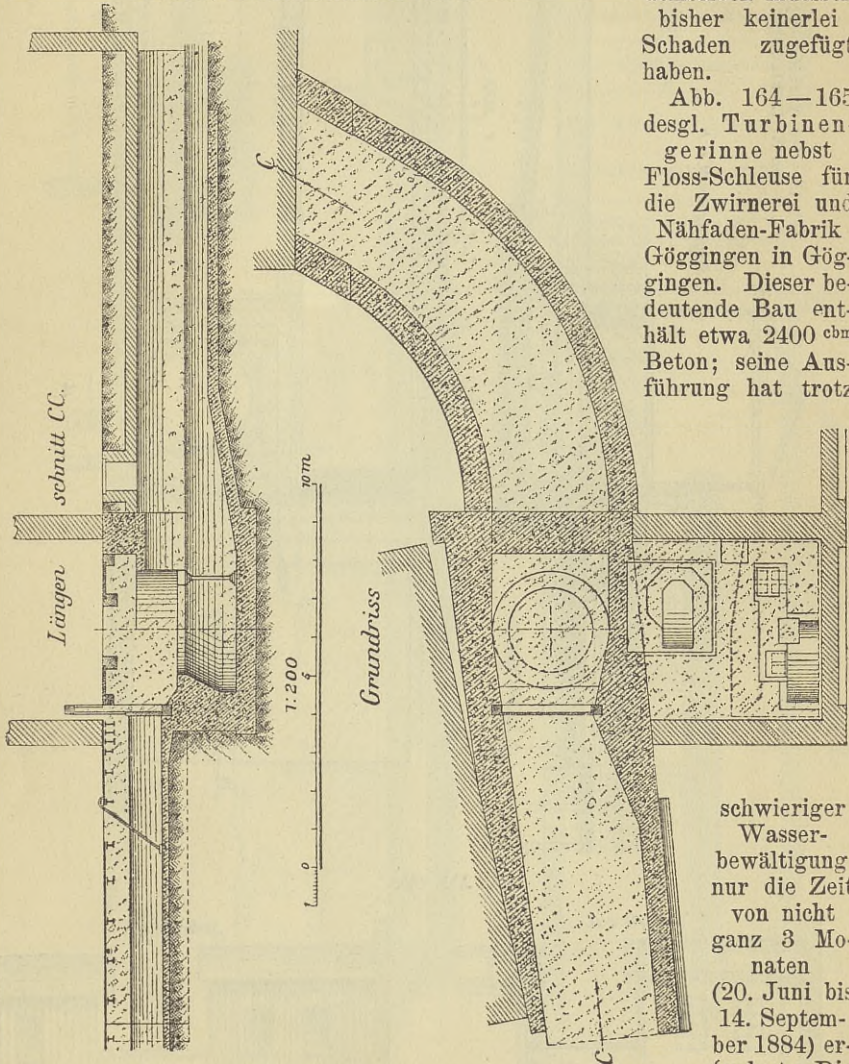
165 desgl. Turbinengerinne nebst Floss-Schleuse für die Zwirnerei und Nähfaden-Fabrik Göggingen in Göggingen. Dieser bedeutende Bau enthält etwa 2400 cbm Beton; seine Ausführung hat trotz
